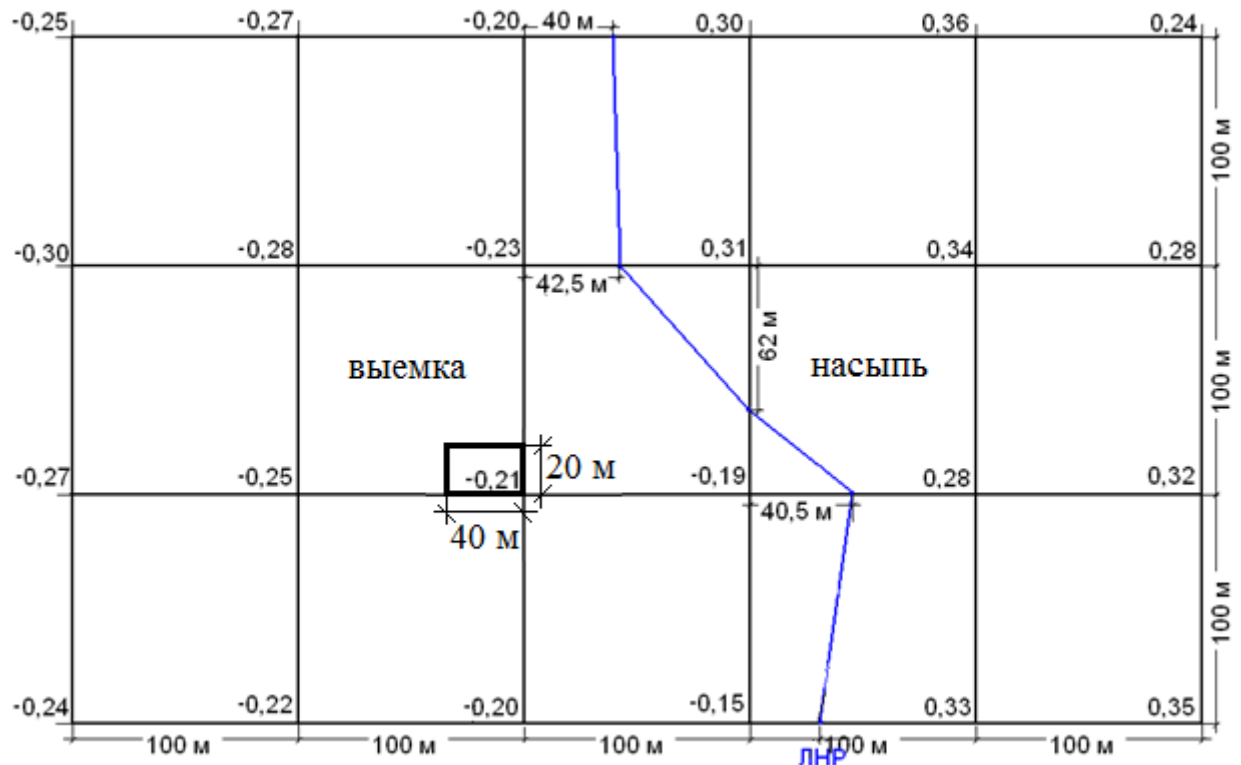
План строительной площадки с рабочими отметками и линией нулевых работ, разделяющей зону выемки и зону насыпи.
